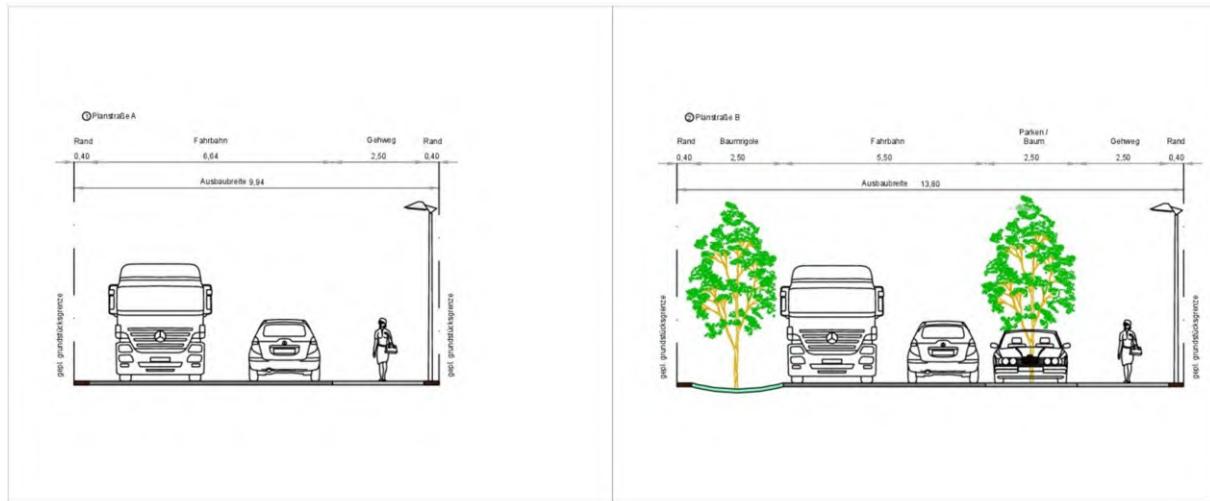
Regelquerschnitte (Skizze) B-Plan Planstraßen A-B
